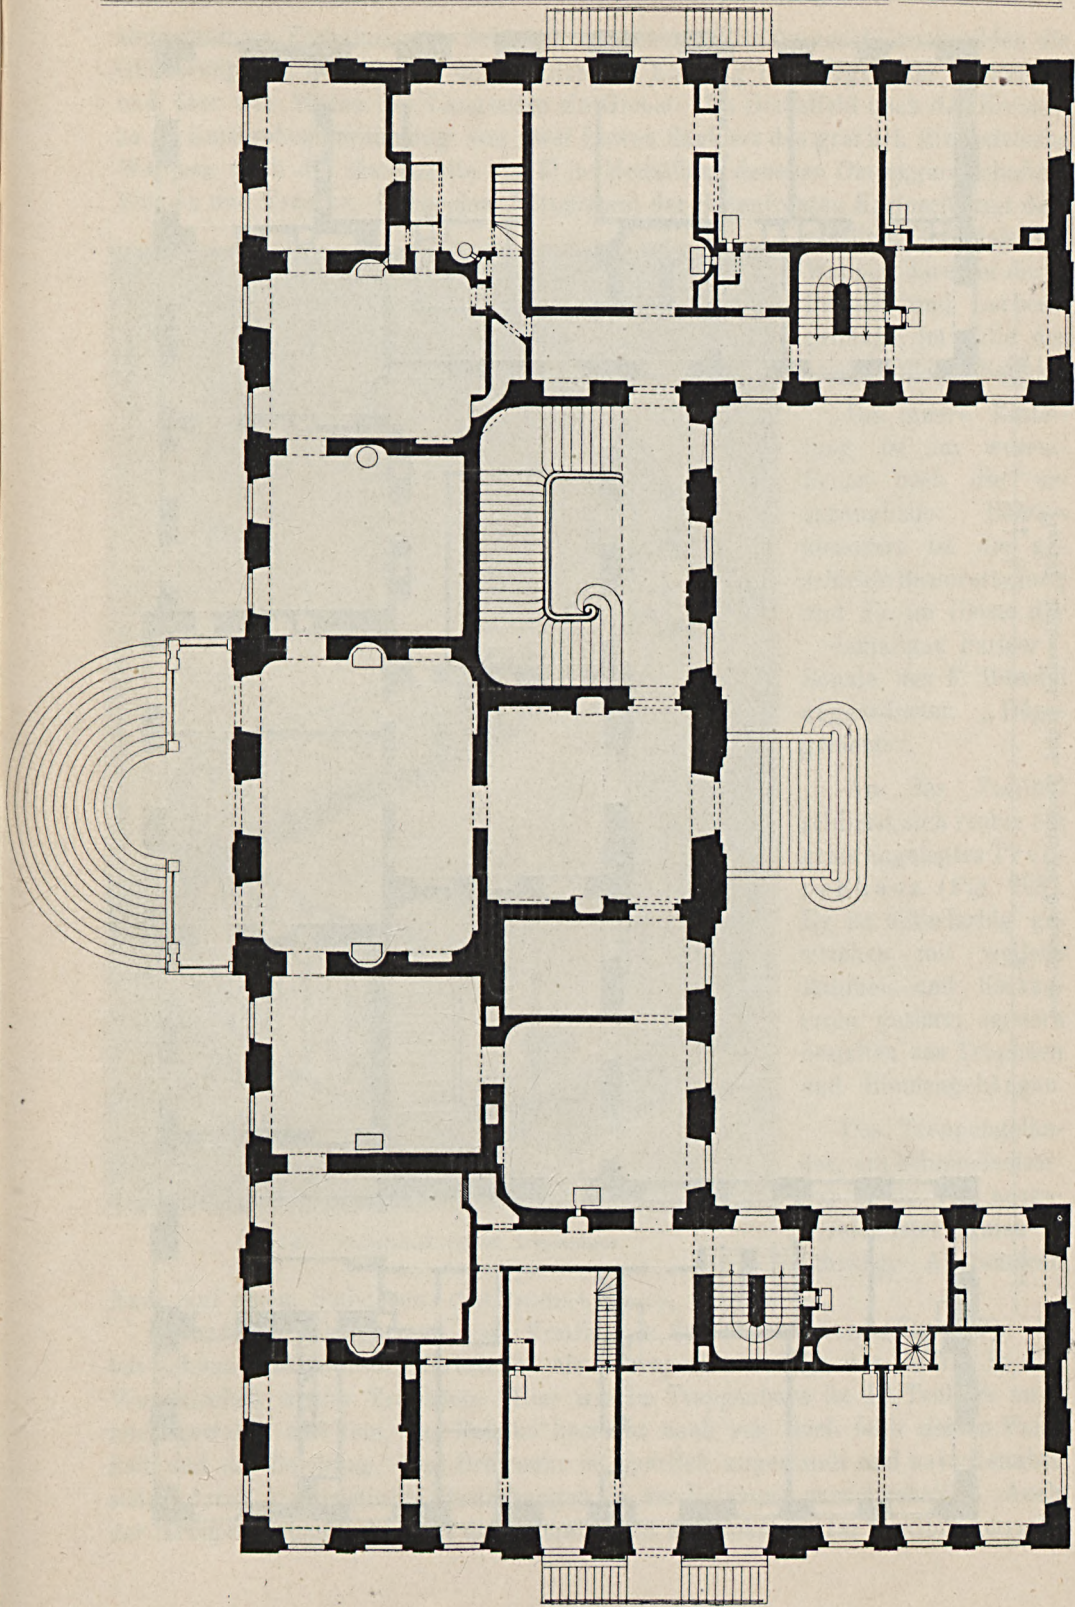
Reibersdorf, Schloß, Grundriß des Untergeschosses.
